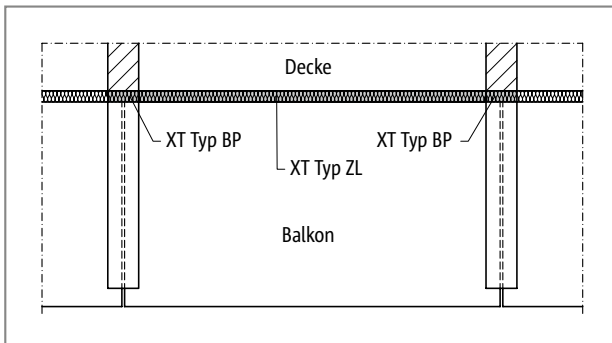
Schöck Isokorb® XT Typ BP: Balkonkonstruktion mit frei auskragenden Unterzügen (Fertigteilbalkon)
